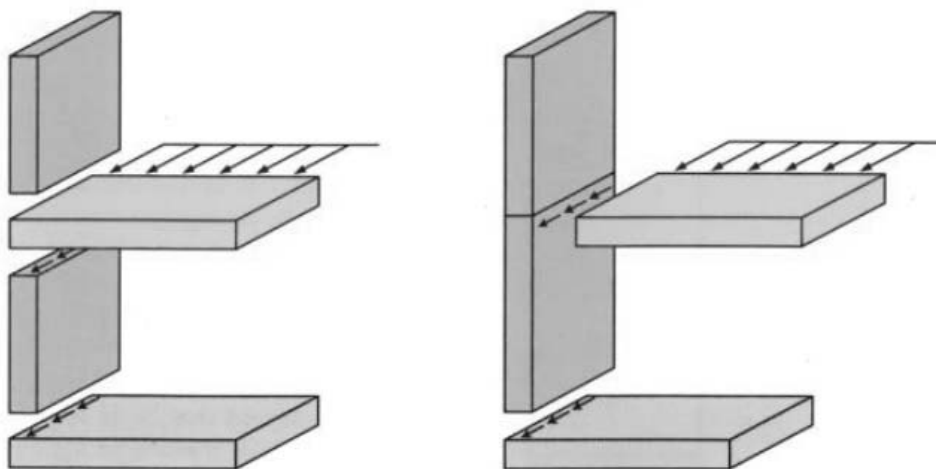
Horisontella laster överförs via bjälklaget till väggskivorna i en byggnad som stabiliseras med skivverkan. (Massivträhandboken 2006)
